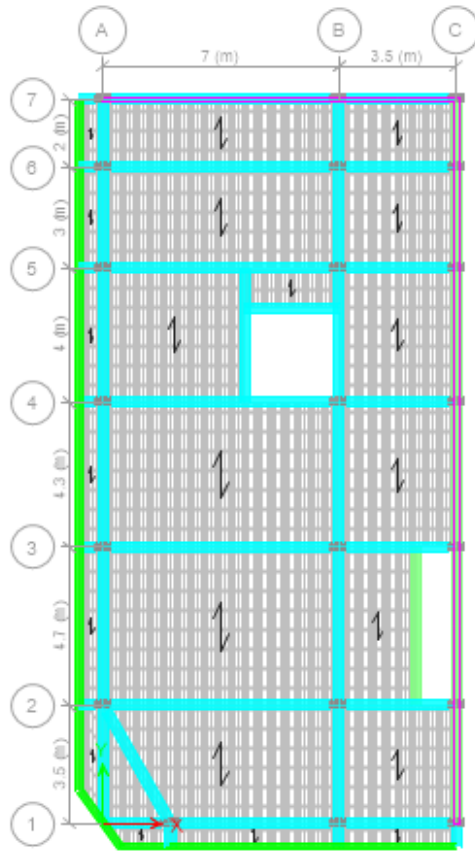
Vista superior de la planta para el modelo matemático planteado. Elaborado por el investigador.
